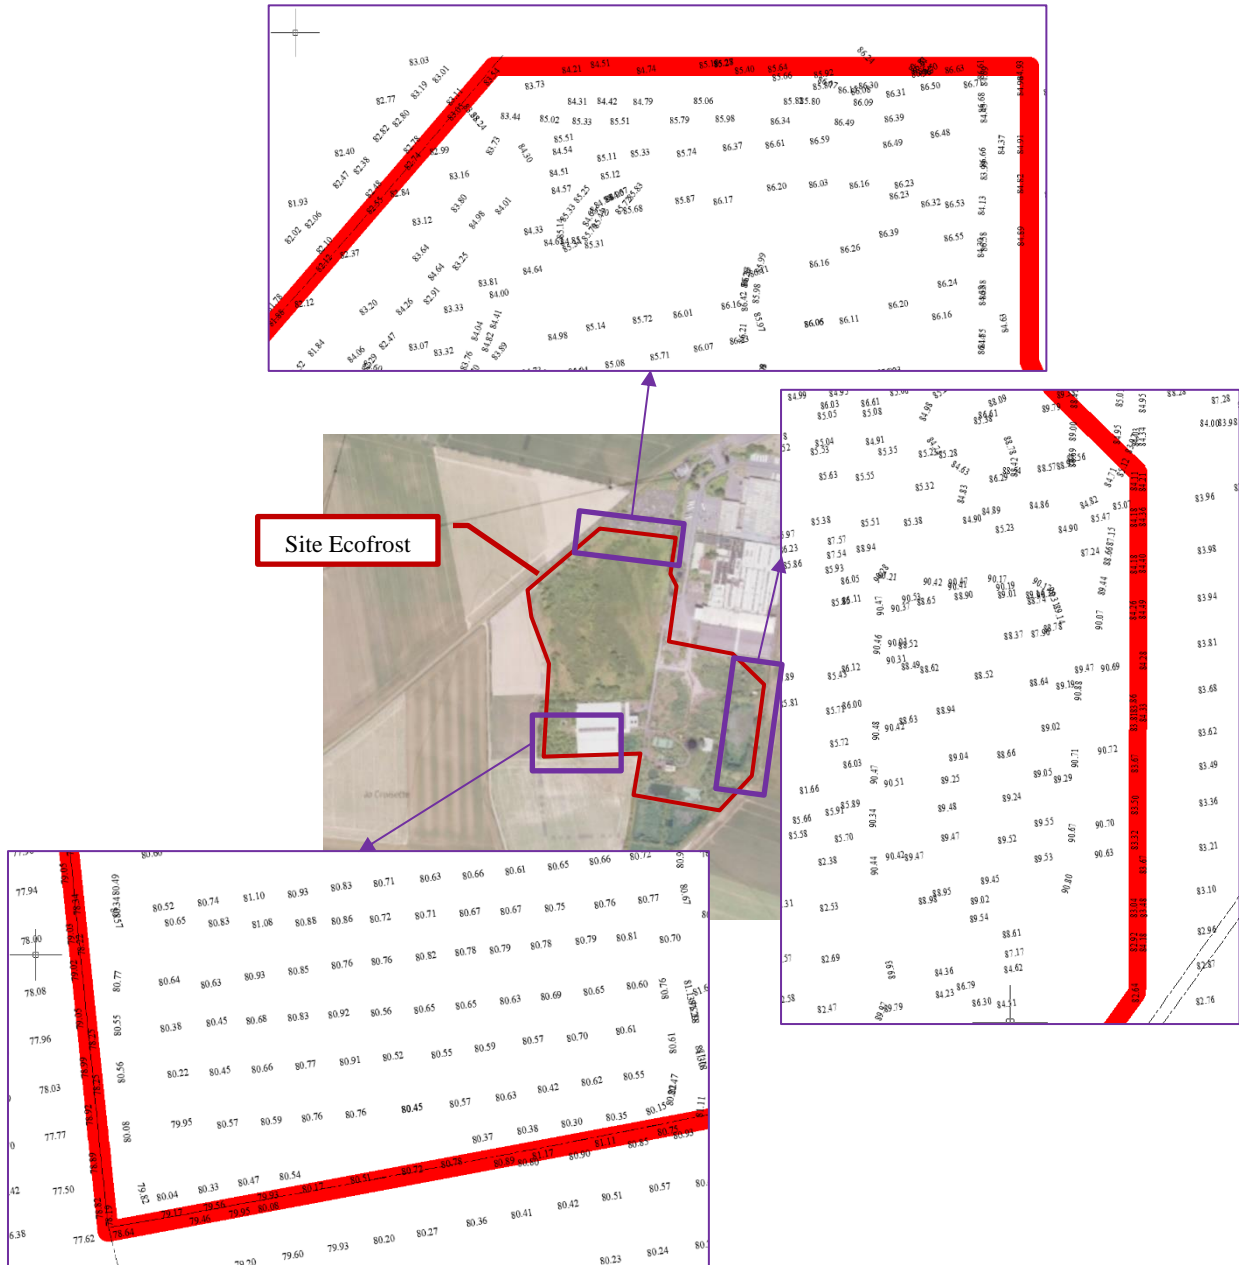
Topographie actuelle du site (Source : Plan de masse Aconstruct, octobre 2021)
